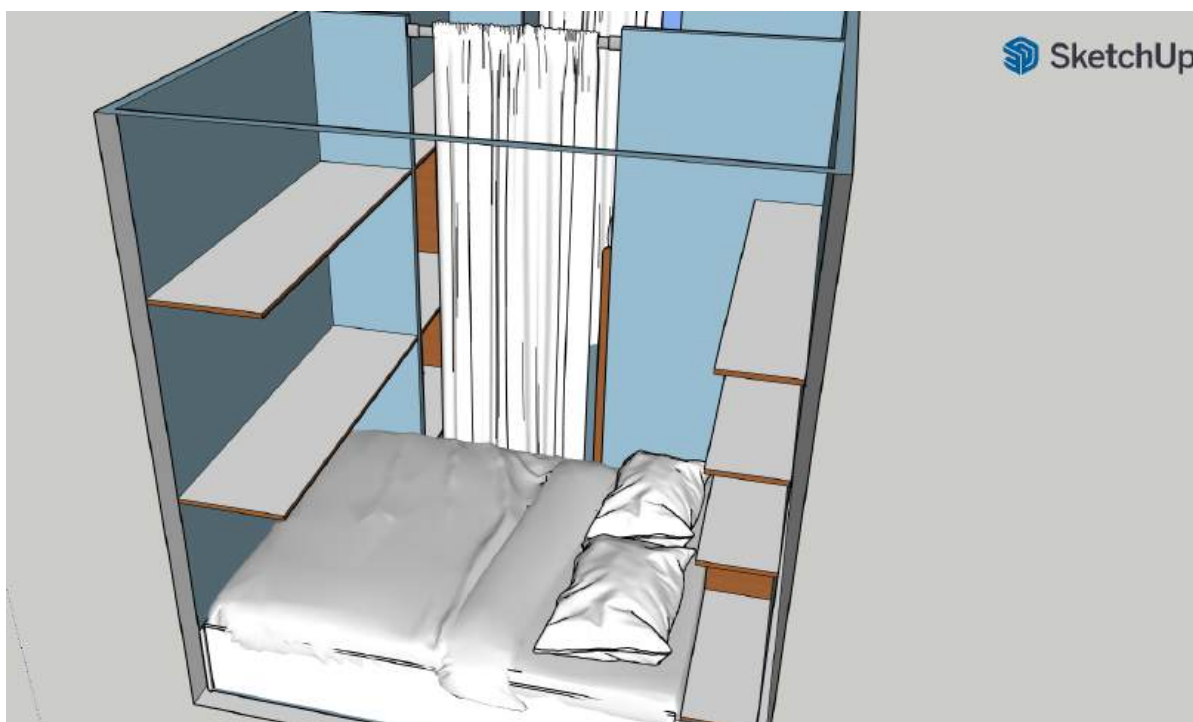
Zijaanzicht slaapruimte 1 vanuit stapelbed
